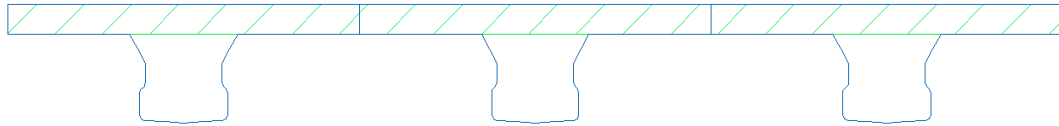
Sección transversal de nervaduras indicando la zona de capa de compresión.
